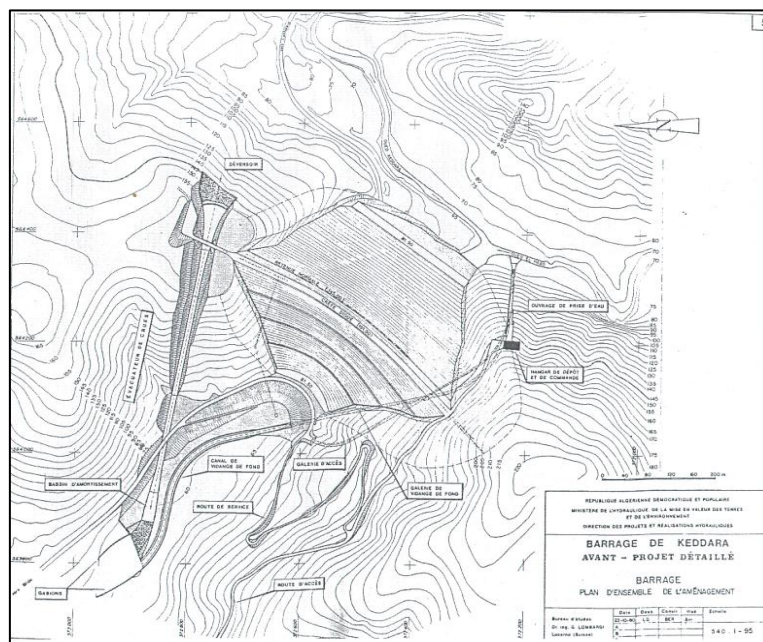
Plan d'ensemble de l'aménagement du barrage de Keddara.
